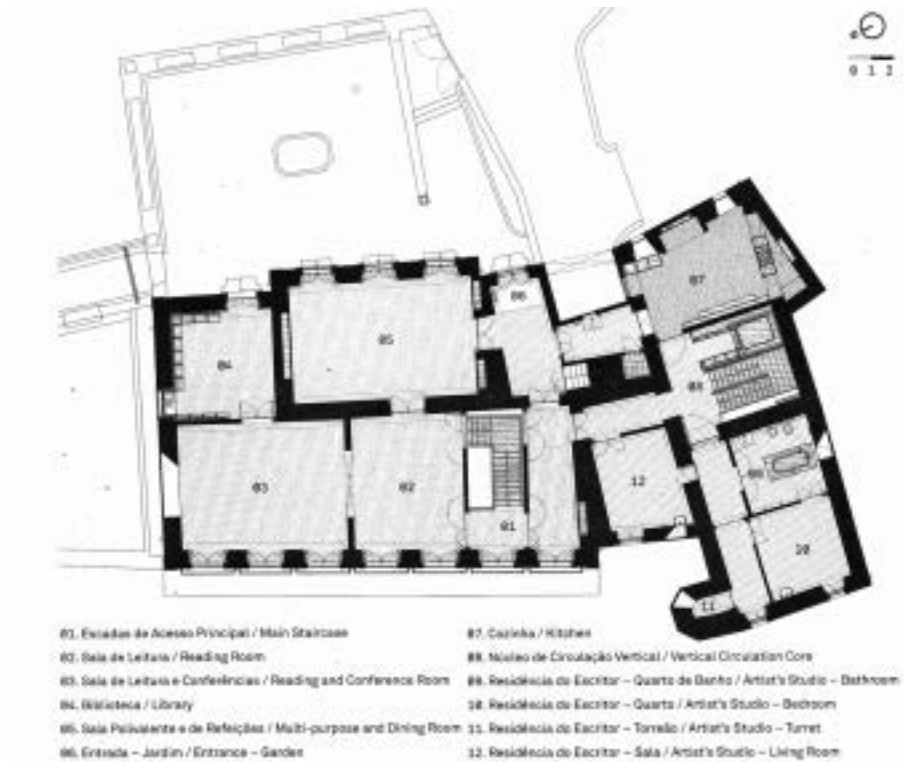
Planta do 1º piso. (Ribeiro, 2013a, p. 127)
